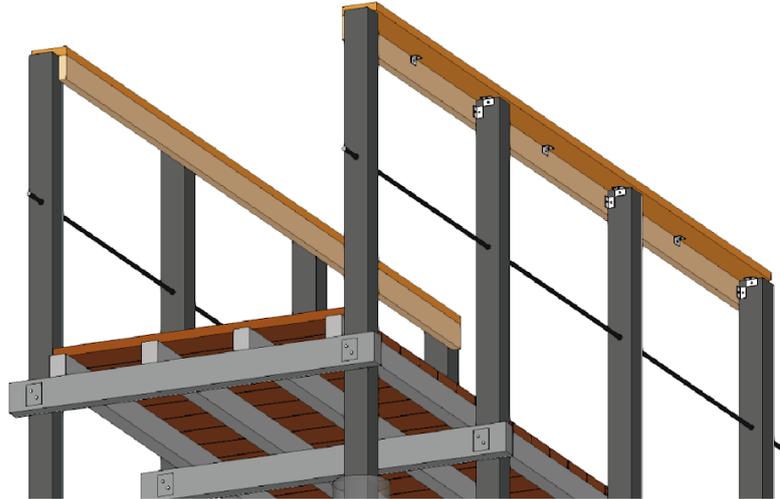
Vista de baixo da estrutura da trilha com detalhe para as cantoneiras de alumínio fixadas com parafuso no guarda corpo e pilar.
